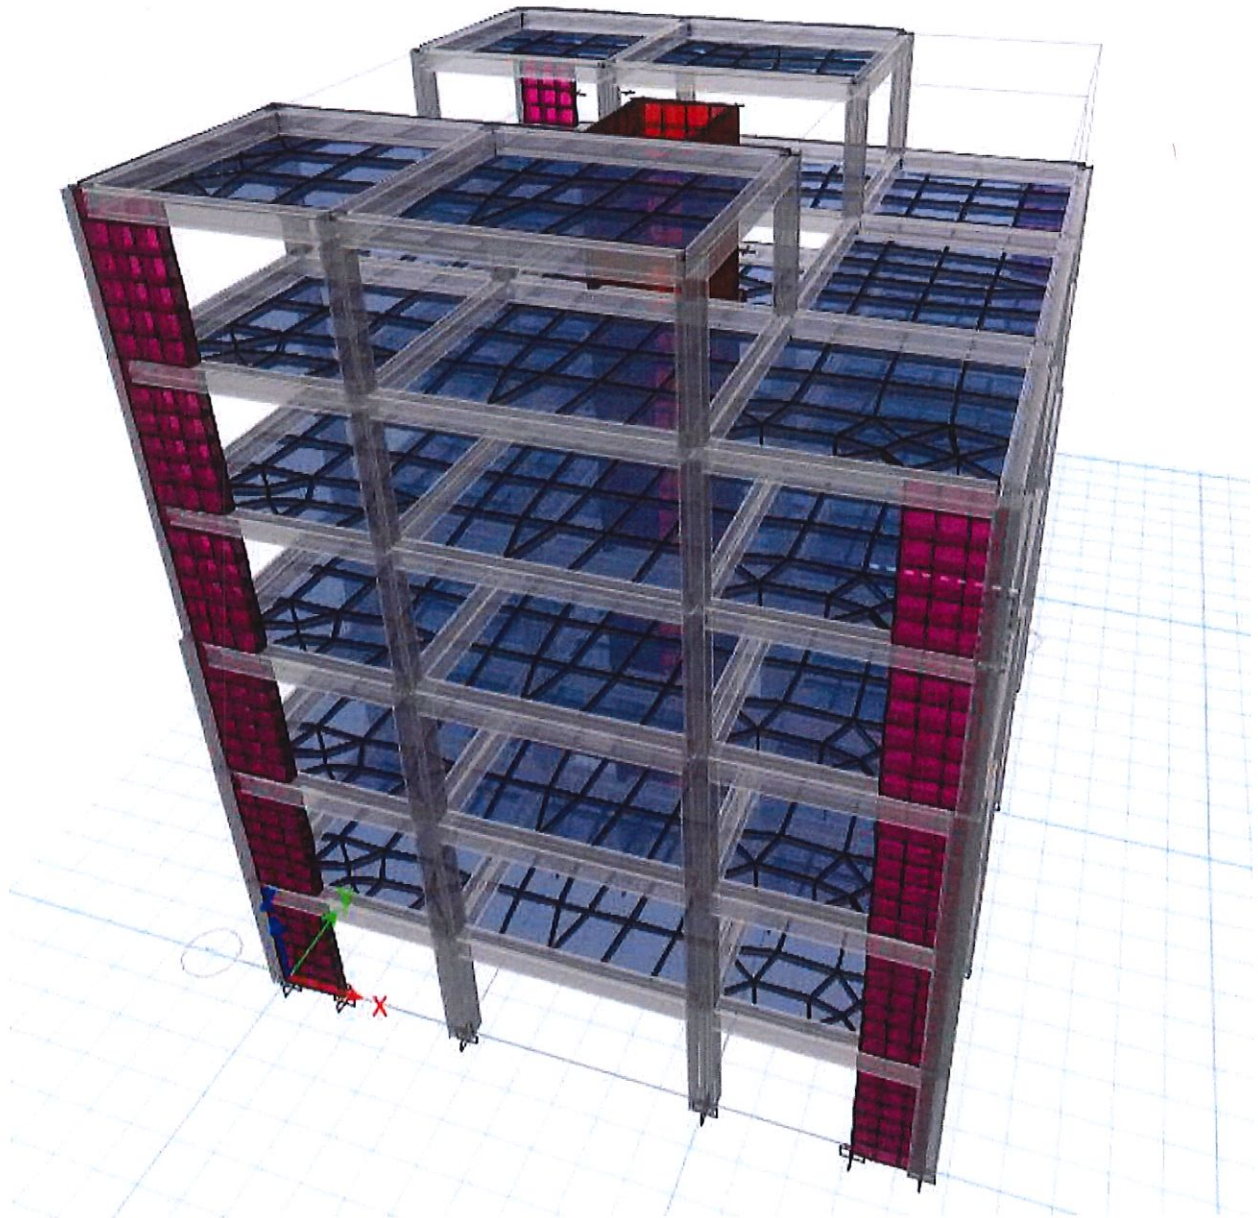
Sistema estructura mixta de pórtico con muros estructurales de Hormigón Armado.
